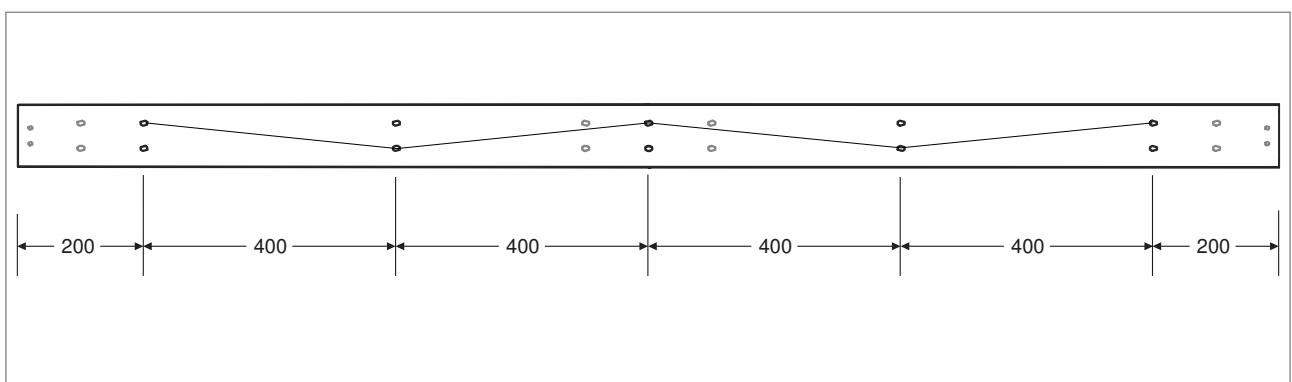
Lochbild bei vertikaler Wand- und Deckenmontage
